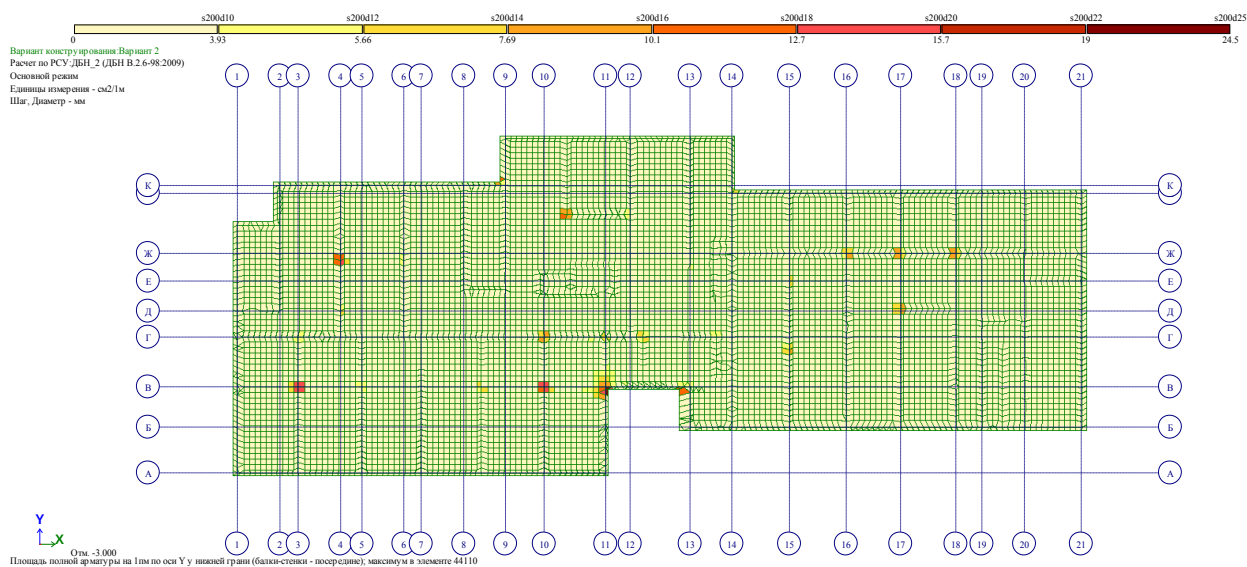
Площадь полной нижней арматуры на 1 м.п. по оси Y
